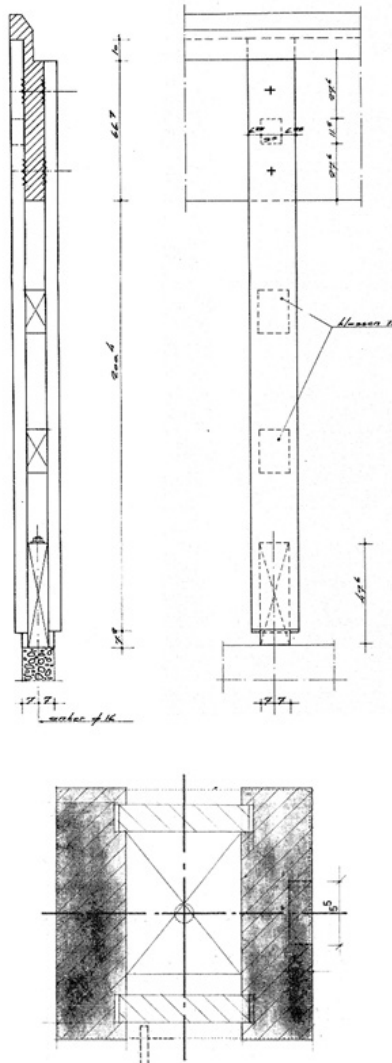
Detalle constructivo (sección y planta) de un pie derecho de madera. Archivo General del Department of Facilities Management de la Universidad de Twente.
